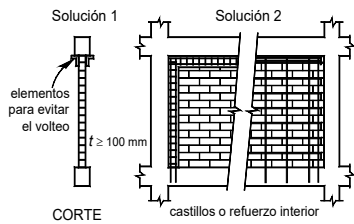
DETALLADO DE MURO DIAFRAGMA
